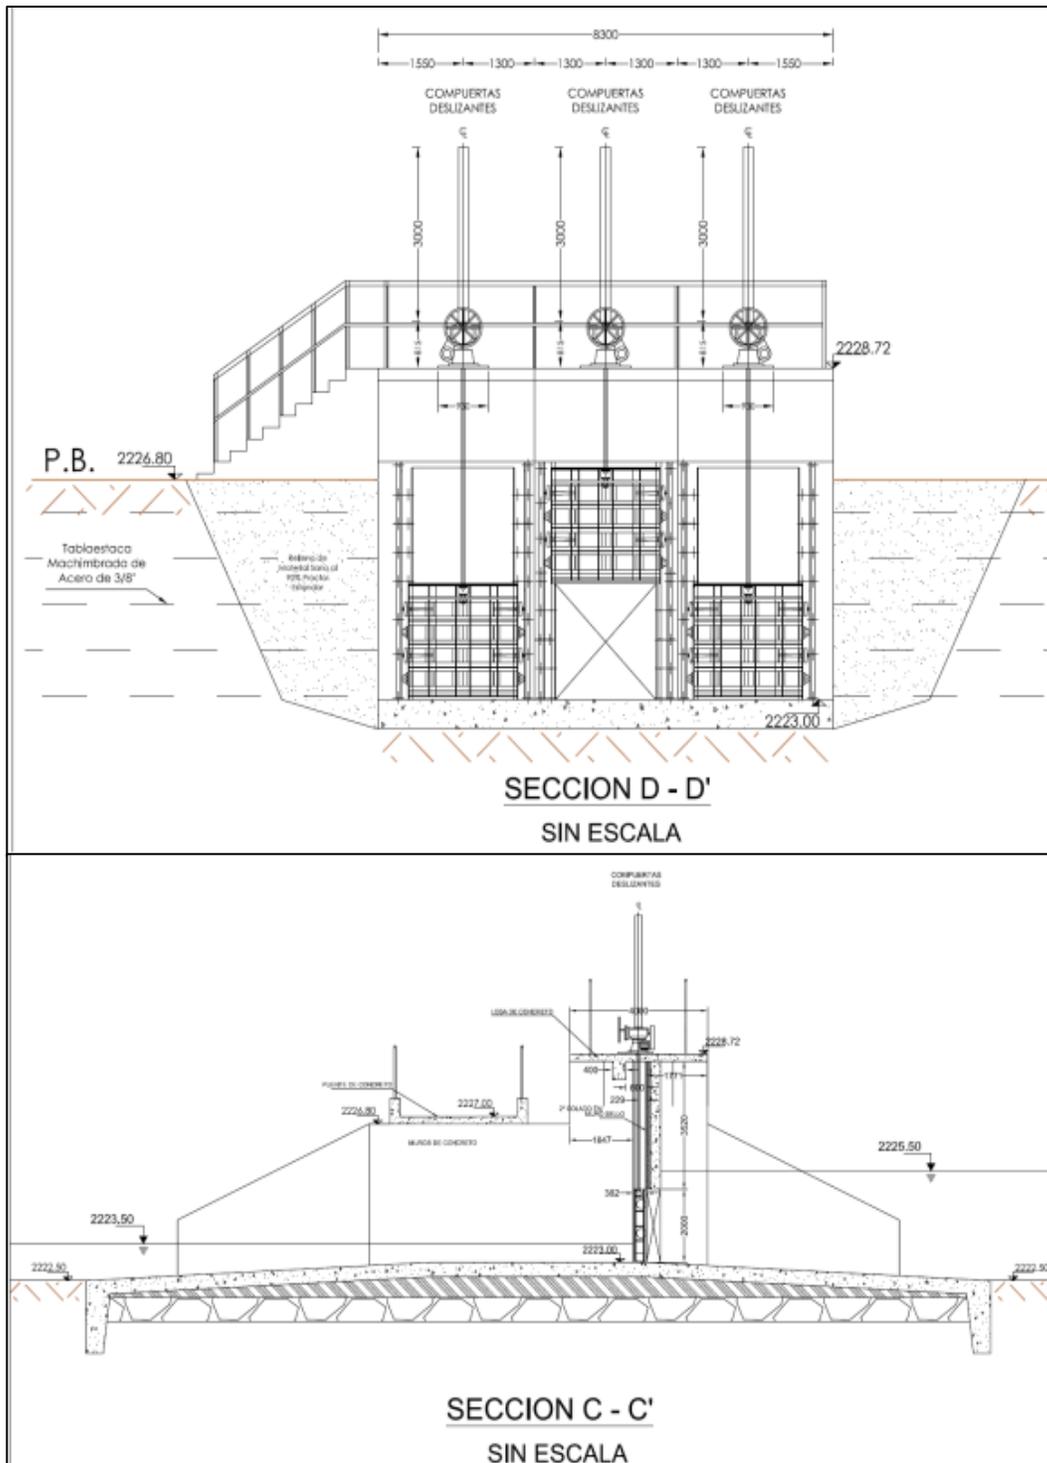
Secciones en elevación de la estructura de control y puente vehicular.
